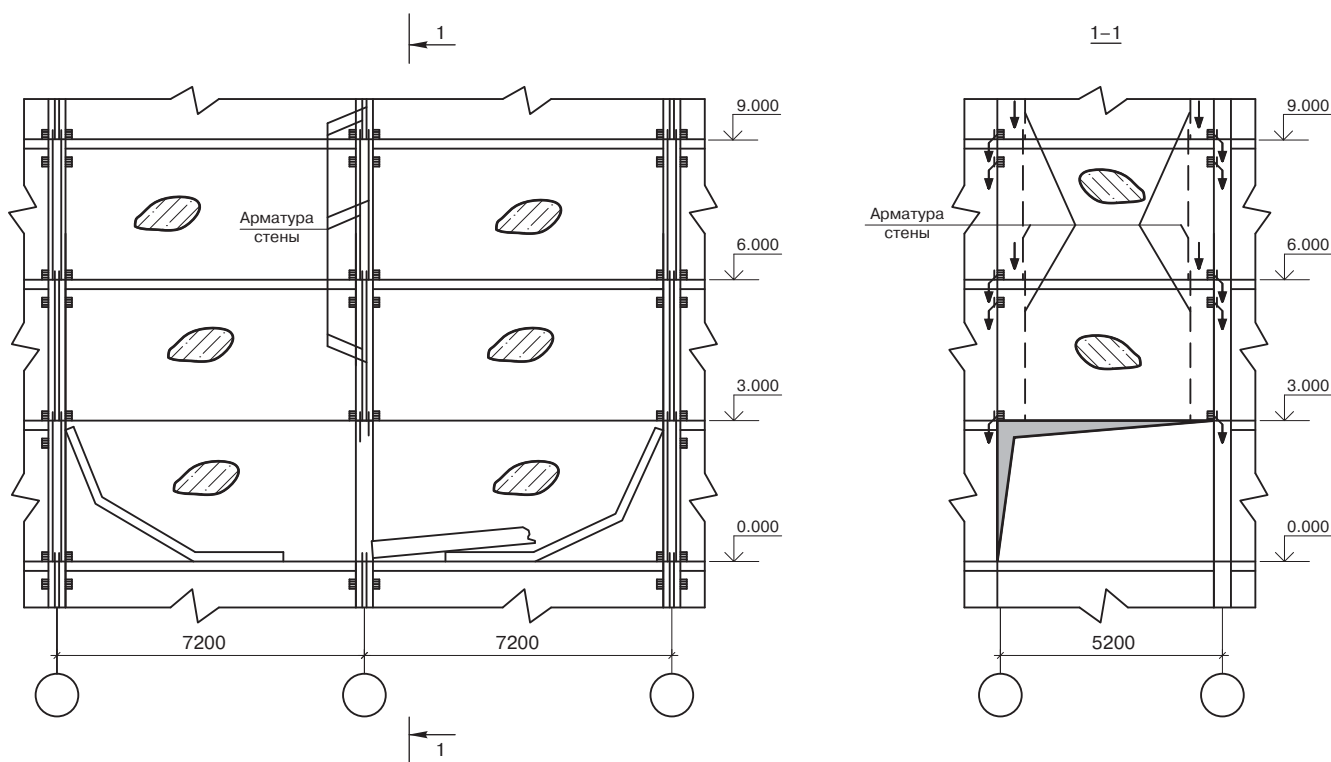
Локальное обрушение несущей стены первого этажа и опирающихся на нее плит перекрытий
